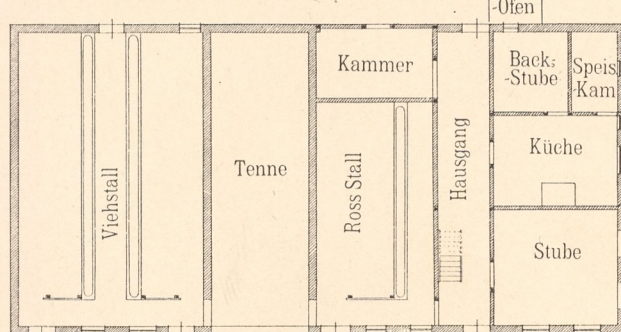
Bauernhaus Nr. 127 in Babenhausen. Erdgeschoss.
